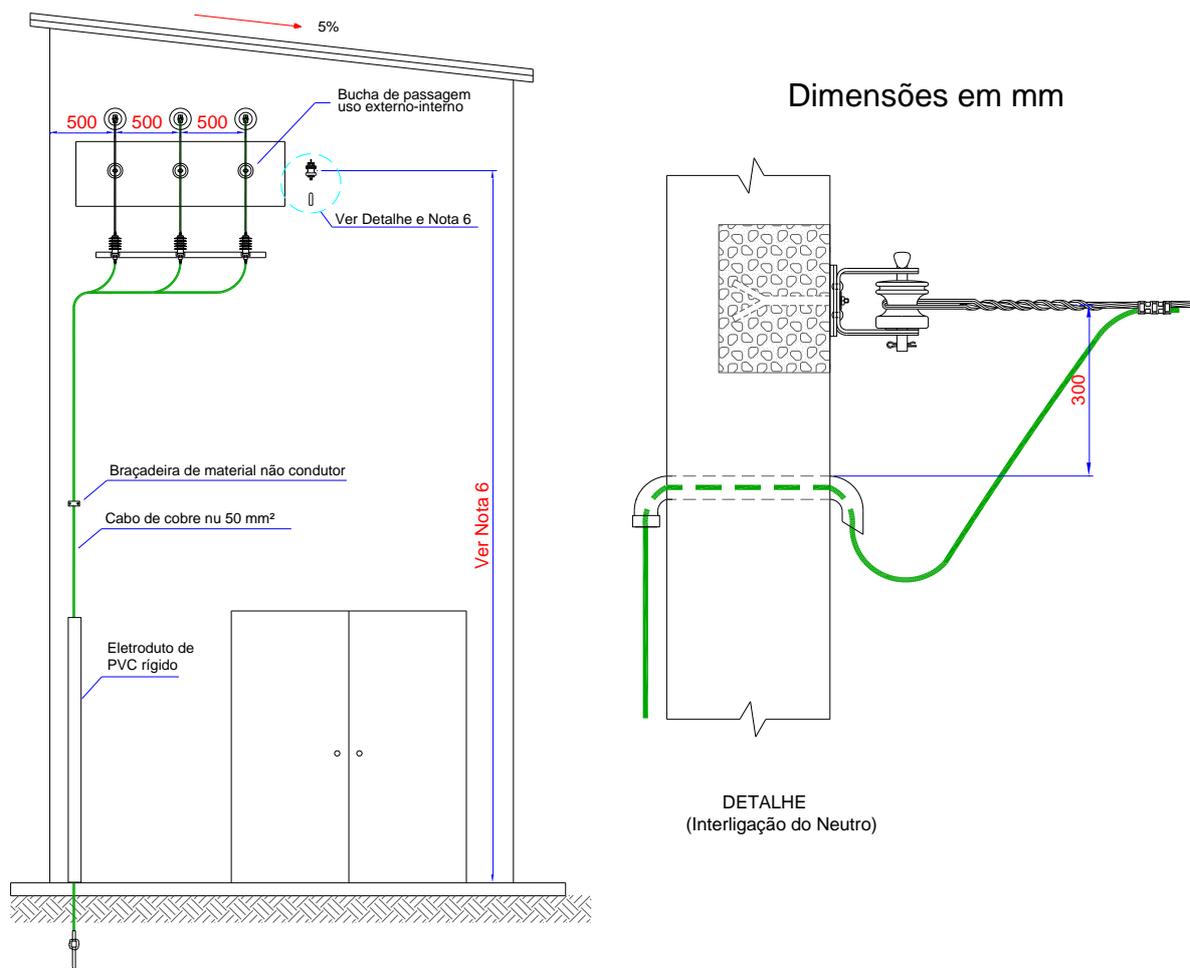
Detalhes Construtivos em Subestações – Instalação de Para-raios (3/4)
